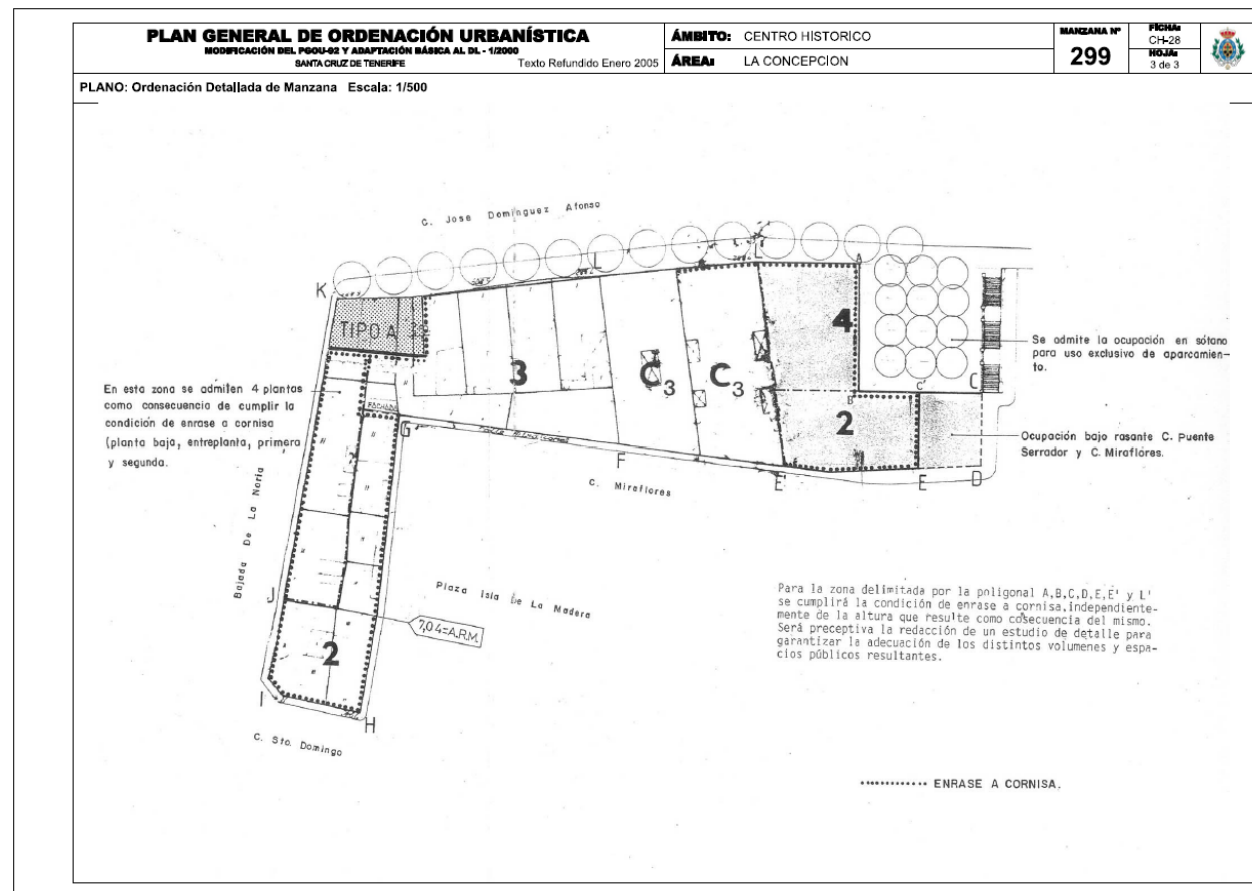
Plano de Ordenación Detallada de Manzana,
